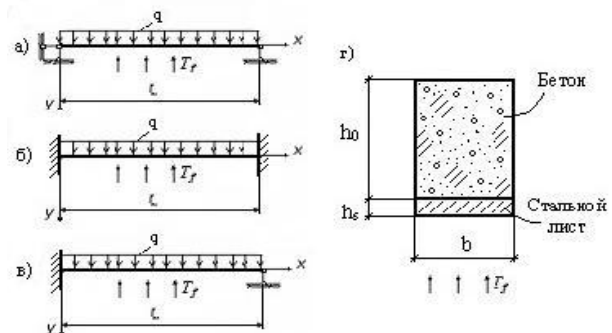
Схемы воздействия на сталобетонные балки (а, б, в); поперечное сечение балок (z)
